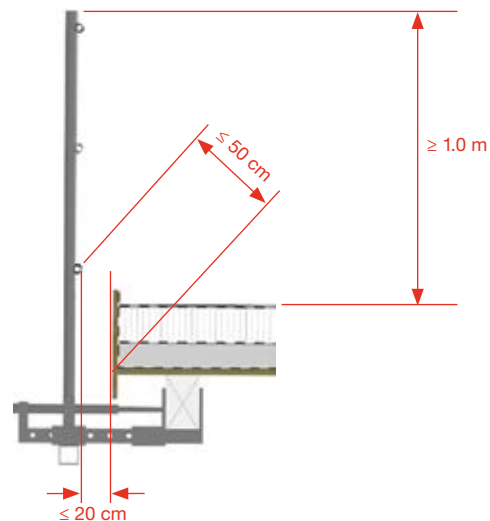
protezione laterale sul lato frontone (sezione) con tubo supplementare
